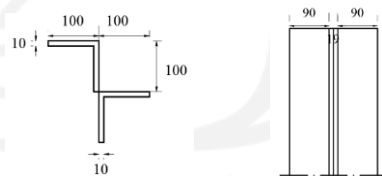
4 Tampak Melintang dan Memanjang Batang Diagonal Tipe 1
